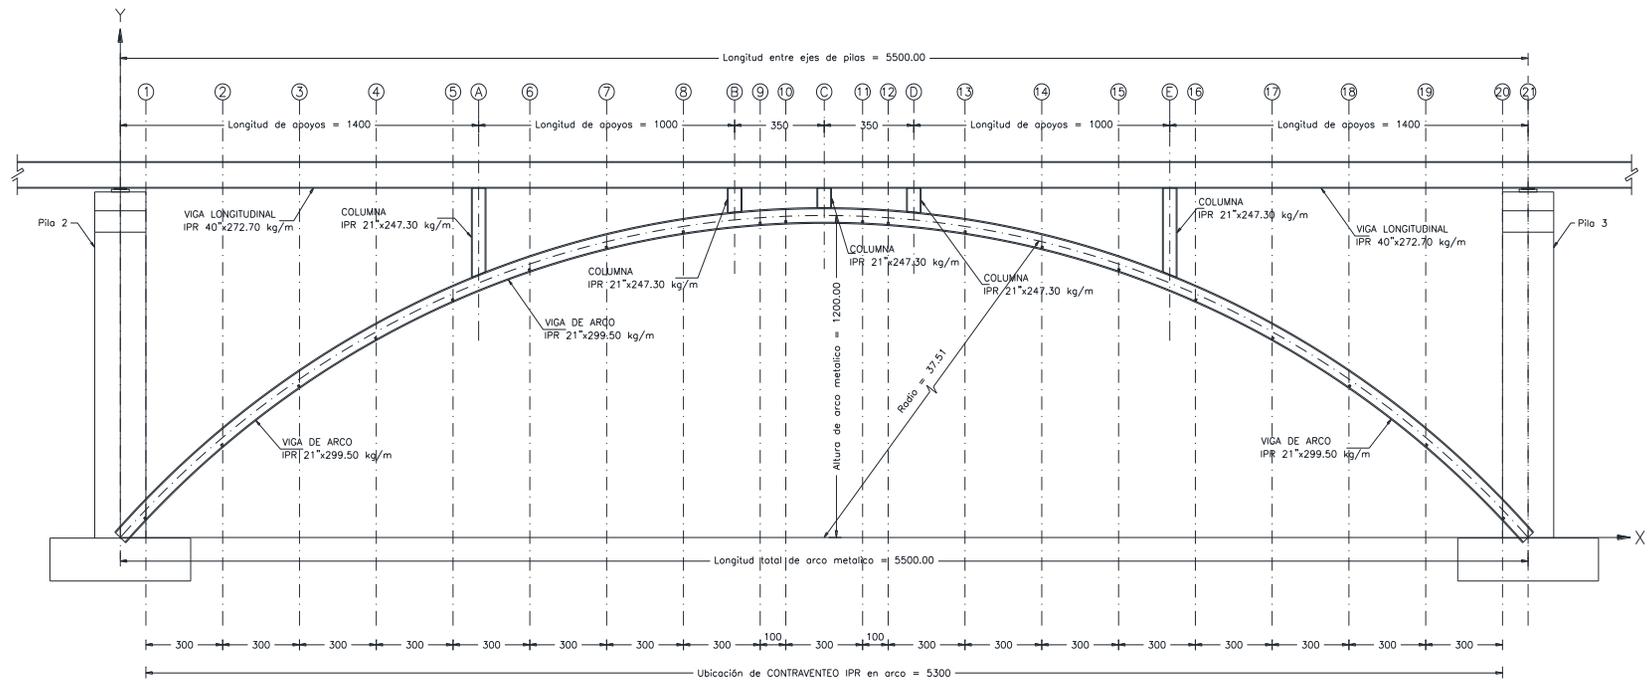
Elevación de contraviento IPR de arco metálico.
